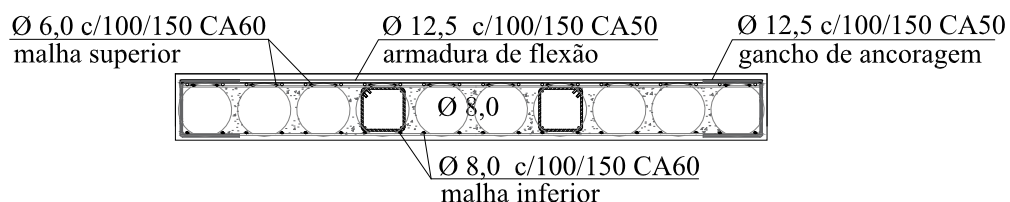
Distribuição em planta da armadura de flexão principal negativa
